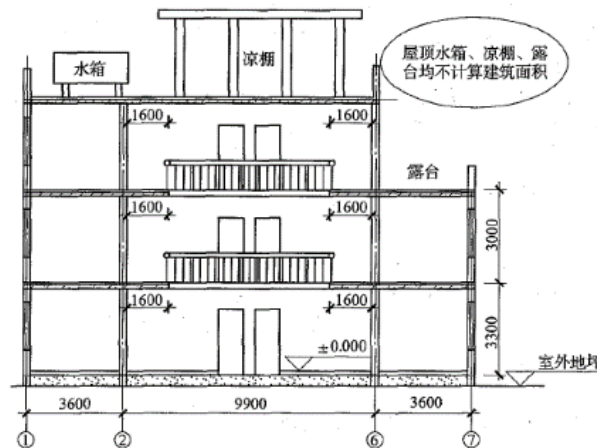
某建筑物屋顶水箱、凉棚、露台平面图
